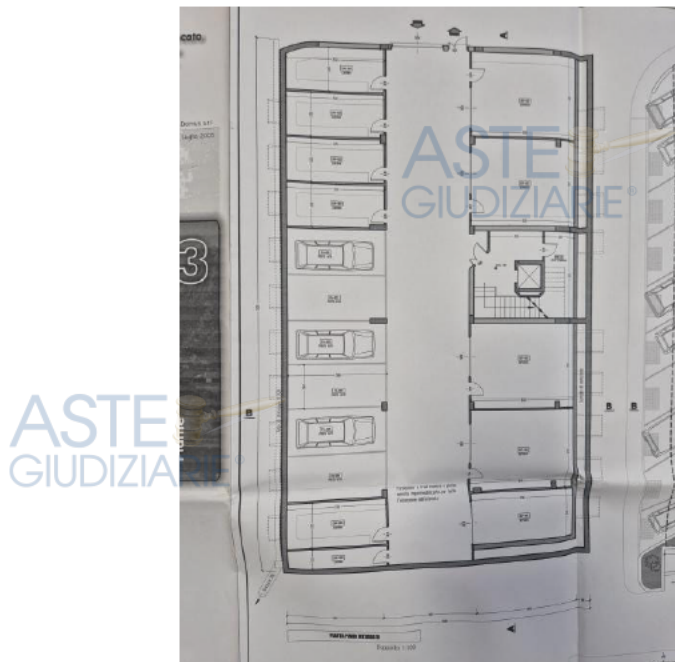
Planimetria secondo la CILA del 12/02/2018 prot. n.811 - LOTTO N.4
